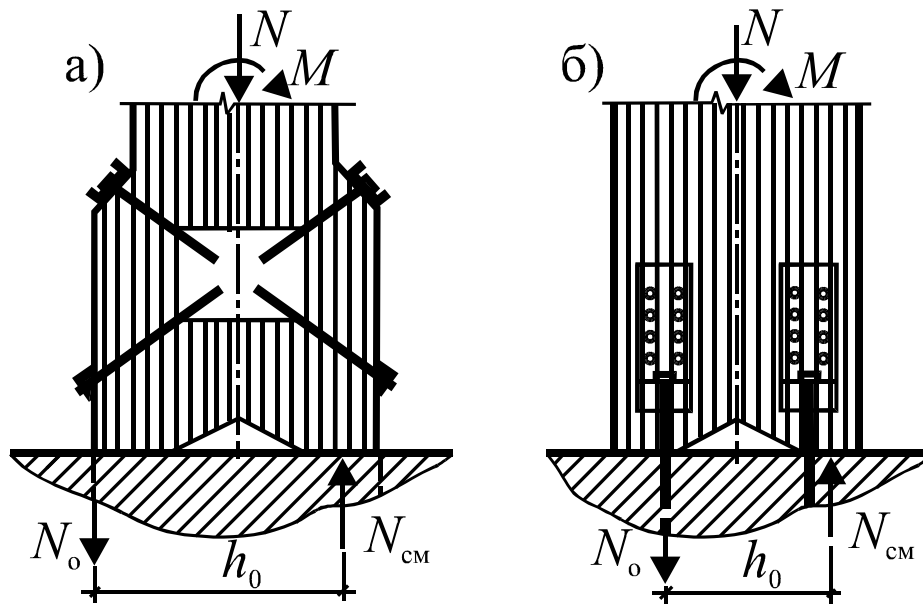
Жёсткие узлы сопряжения стоек с фундаментами
